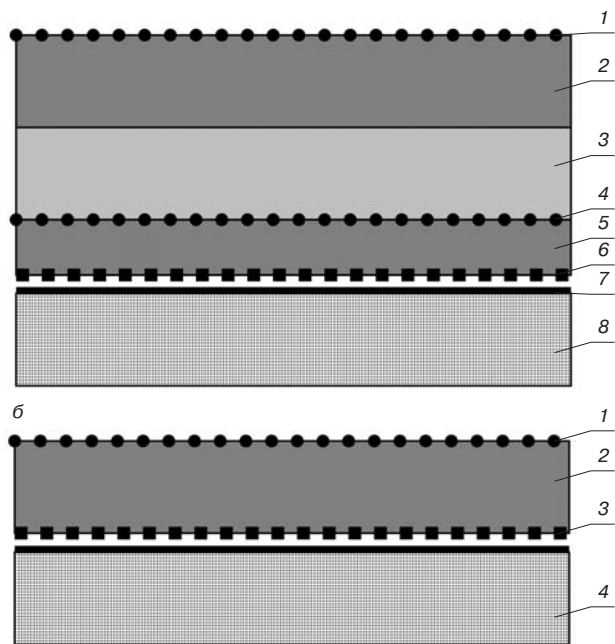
Конструкции дорожной одежды мостового полотна, рекоменду- емые к применению на железобетонной плите А: с покрытием из литой асфальтобетонной смеси: а – проезжая часть: 1 – россыпь черного щебня фр. 5–10 мм, расход 5–8 кг/м²; 2 – литой асфальтобетон I или II типа, слоем 40 мм; 3 – асфальтобетон типа А, Б, слоем 40 мм; 4 – рос- сыпь щебня фр. 5–10 мм, расход 7–10 кг/м²; 5 – мастика изолирующая, расход 55 кг/м², слоем 20 мм; 6 – сетка из полиэстера; 7 – разжиженное битумно-полимерное вяжущее, расход 0,5–0,6 кг/м²; 8 – железобетон- ная плита; б – тротуар: 1 – россыпь черного щебня фр. 5–10 мм, рас- ход 5–8 кг/м²; 2 – литой асфальтобетон IV типа, слоем 40 мм; 3 – сетка из полиэстера; 4 – железобетонная плита
